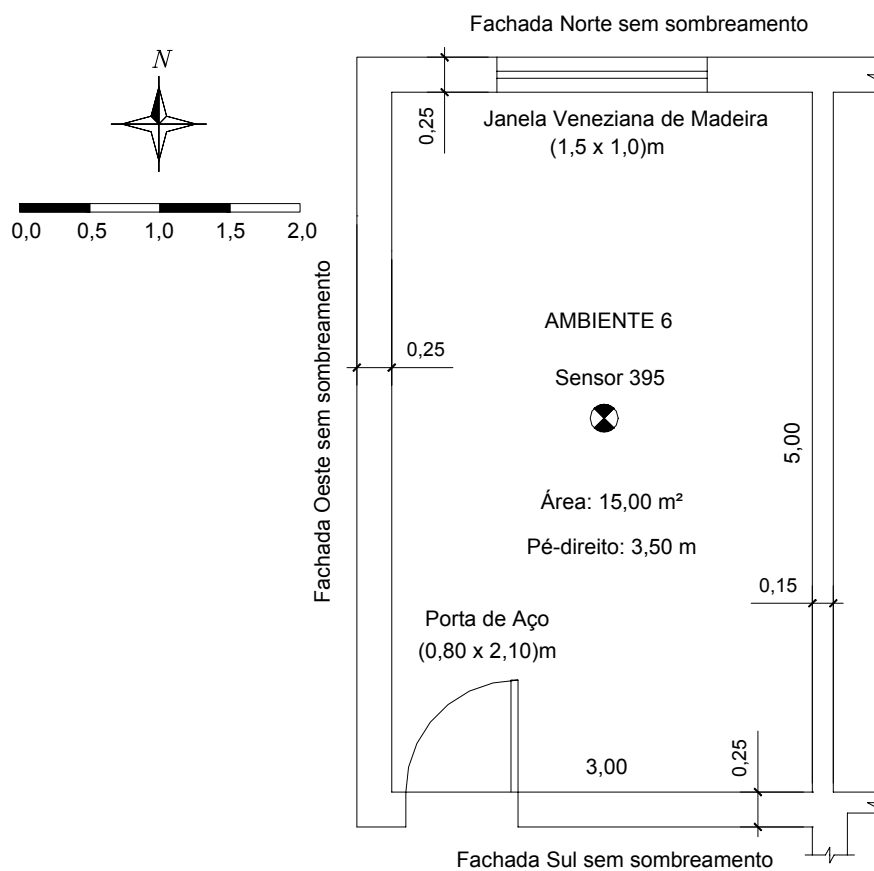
Planta baixa do ambiente monitorado - Edificação 6.
